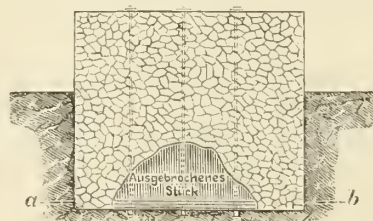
Während der Senkung zerstörter Brunnen. Seitenansicht.
